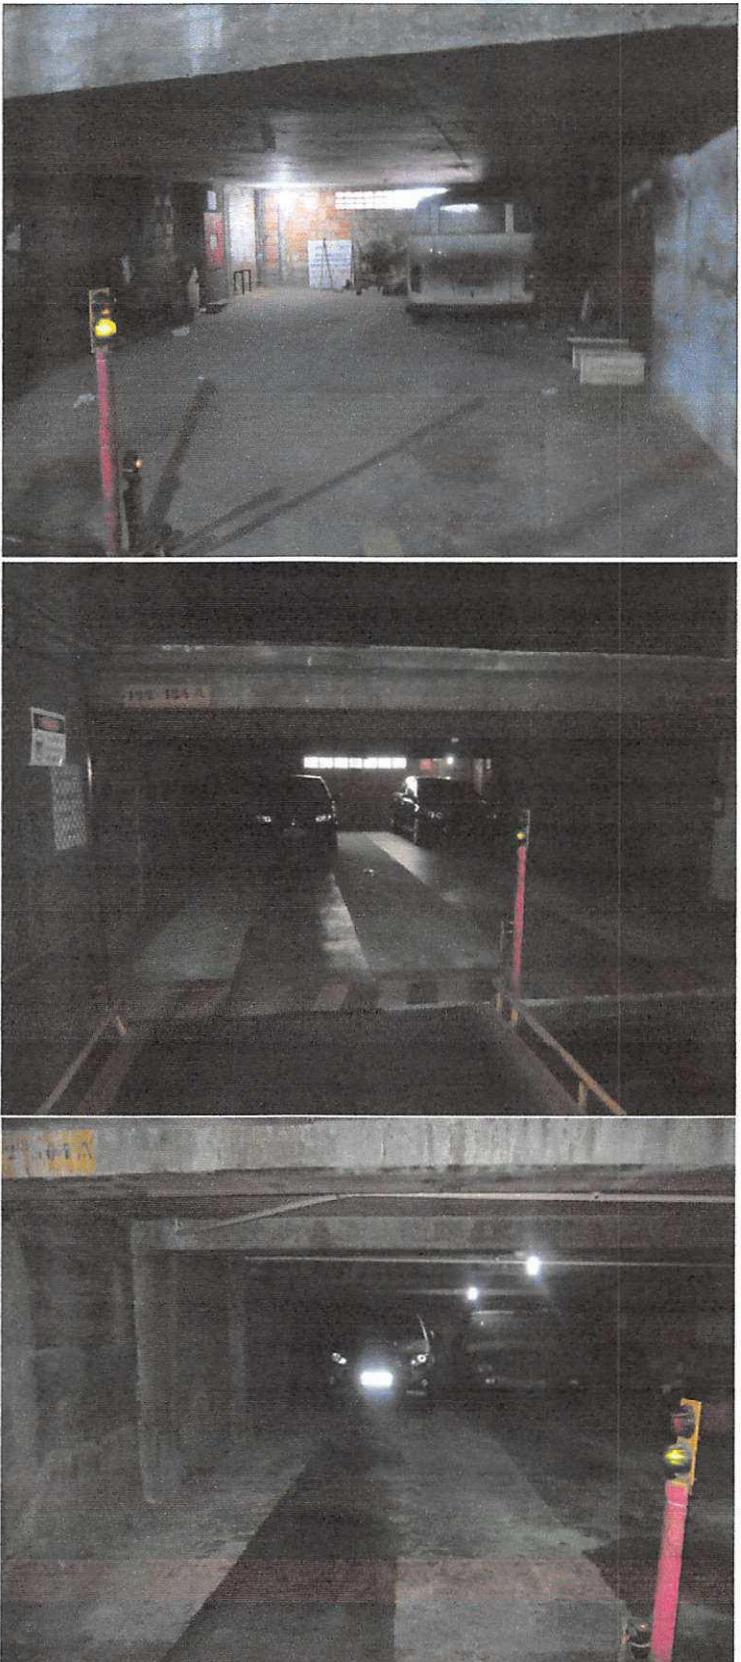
/08 - Vistas parciais do pavimento térreo e do elevador de veículos.
